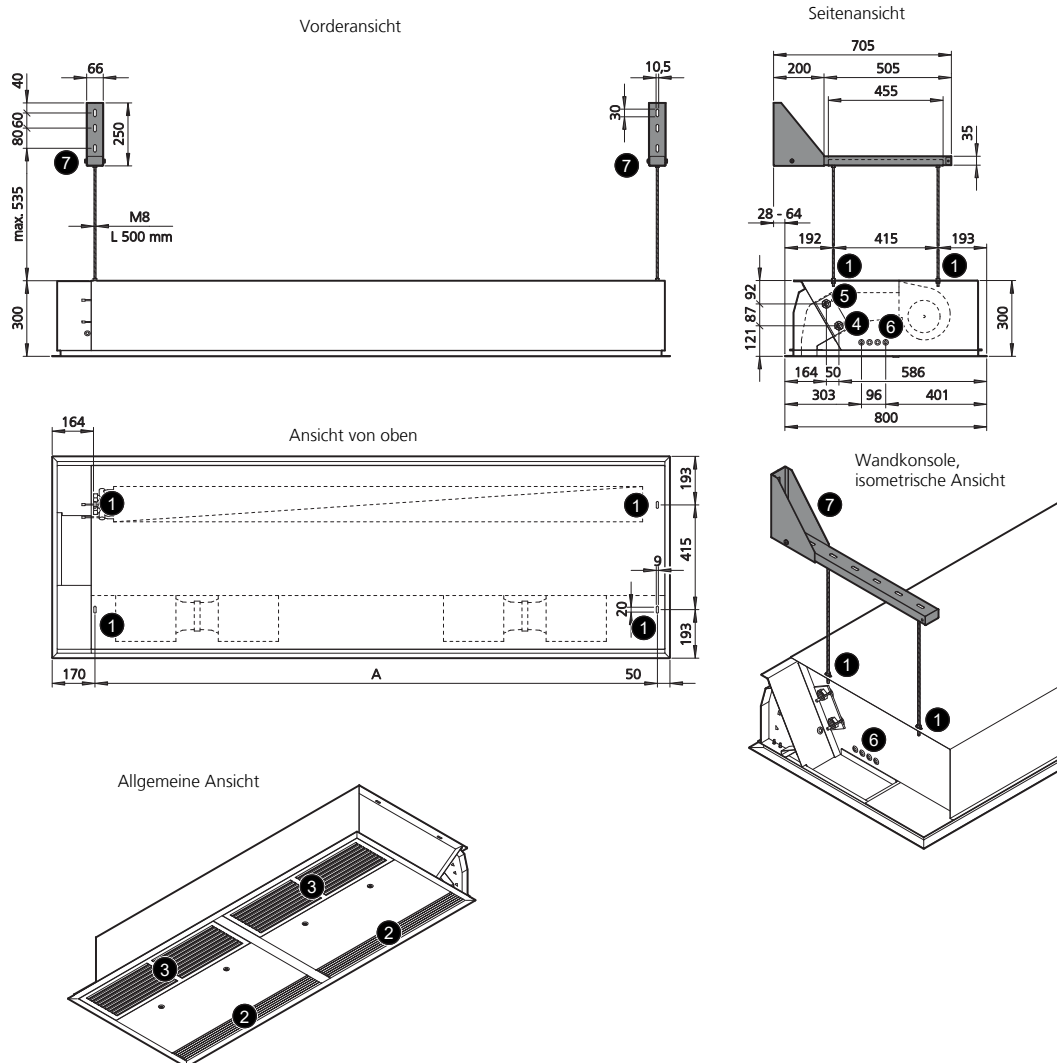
Aufhängepunkte Tandem 300 Deckeneinbau BG 12 - 30 mit Wandkonsolen
